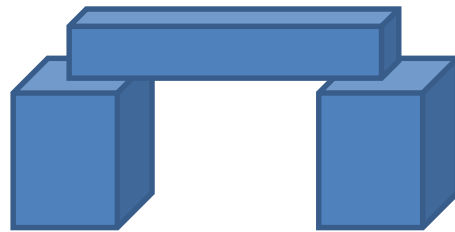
Esquema de elemento tipo viga, simplemente apoyado
